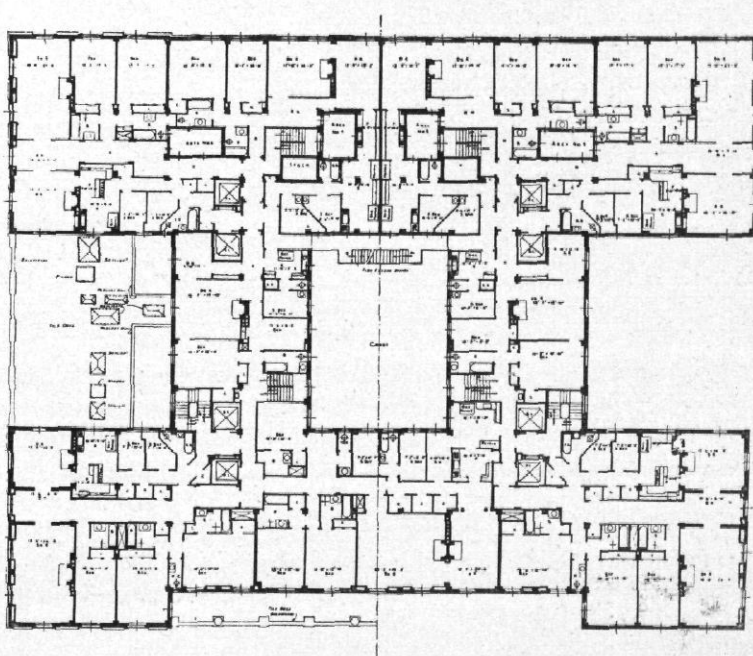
/ Devonsbire House, Piccadilly, London / Grundriß der Obergeschosse 1 : 600
